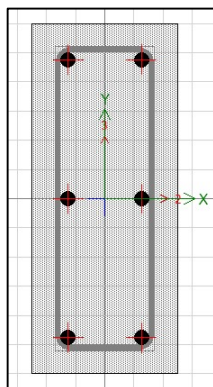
Vista en planta columna C04 (Eje C-2)
